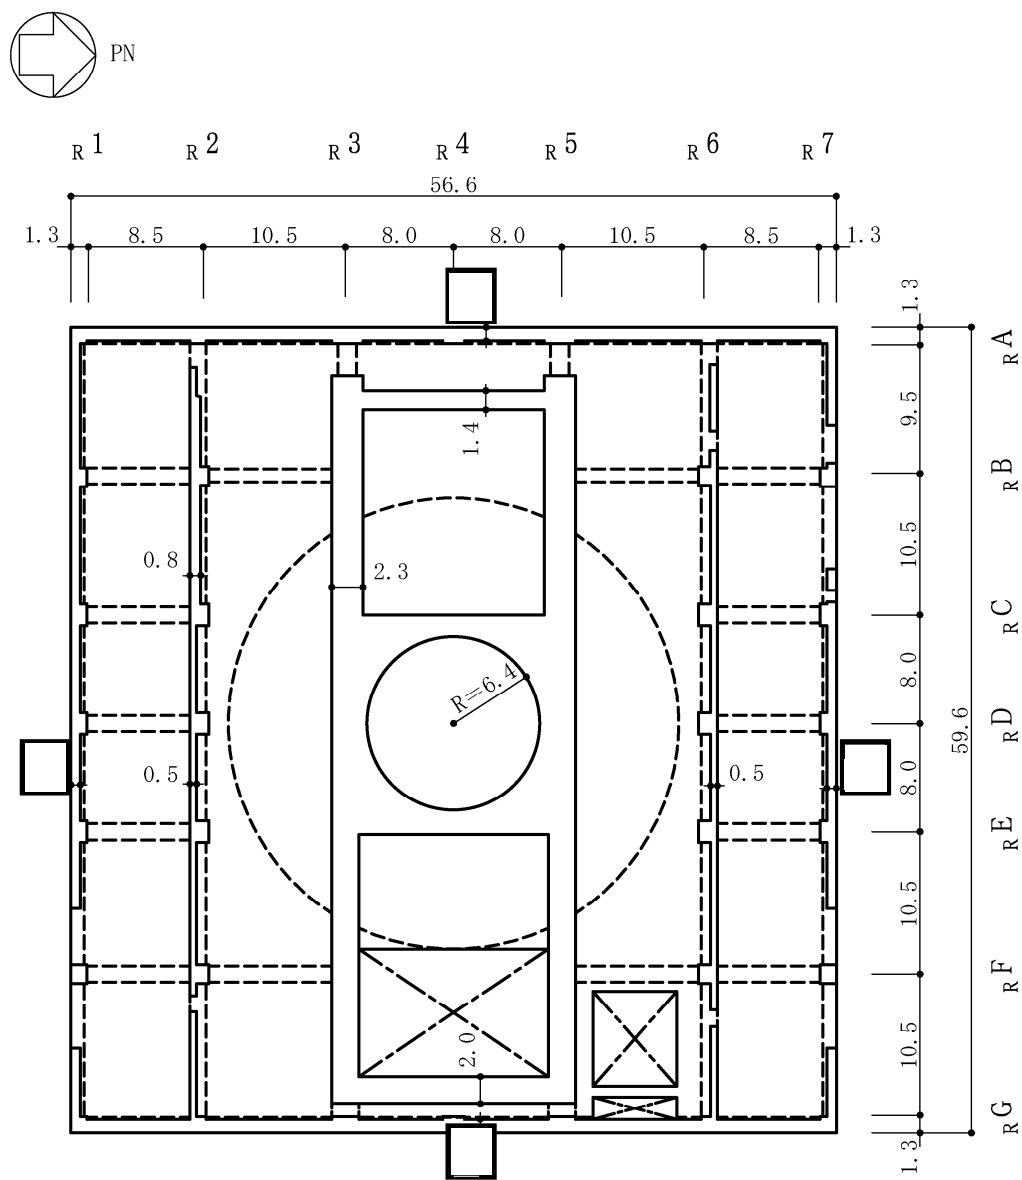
原子炉建屋の概略平面図 (3F, T.M.S.L. 23.5m) (単位:m) (6/9)
